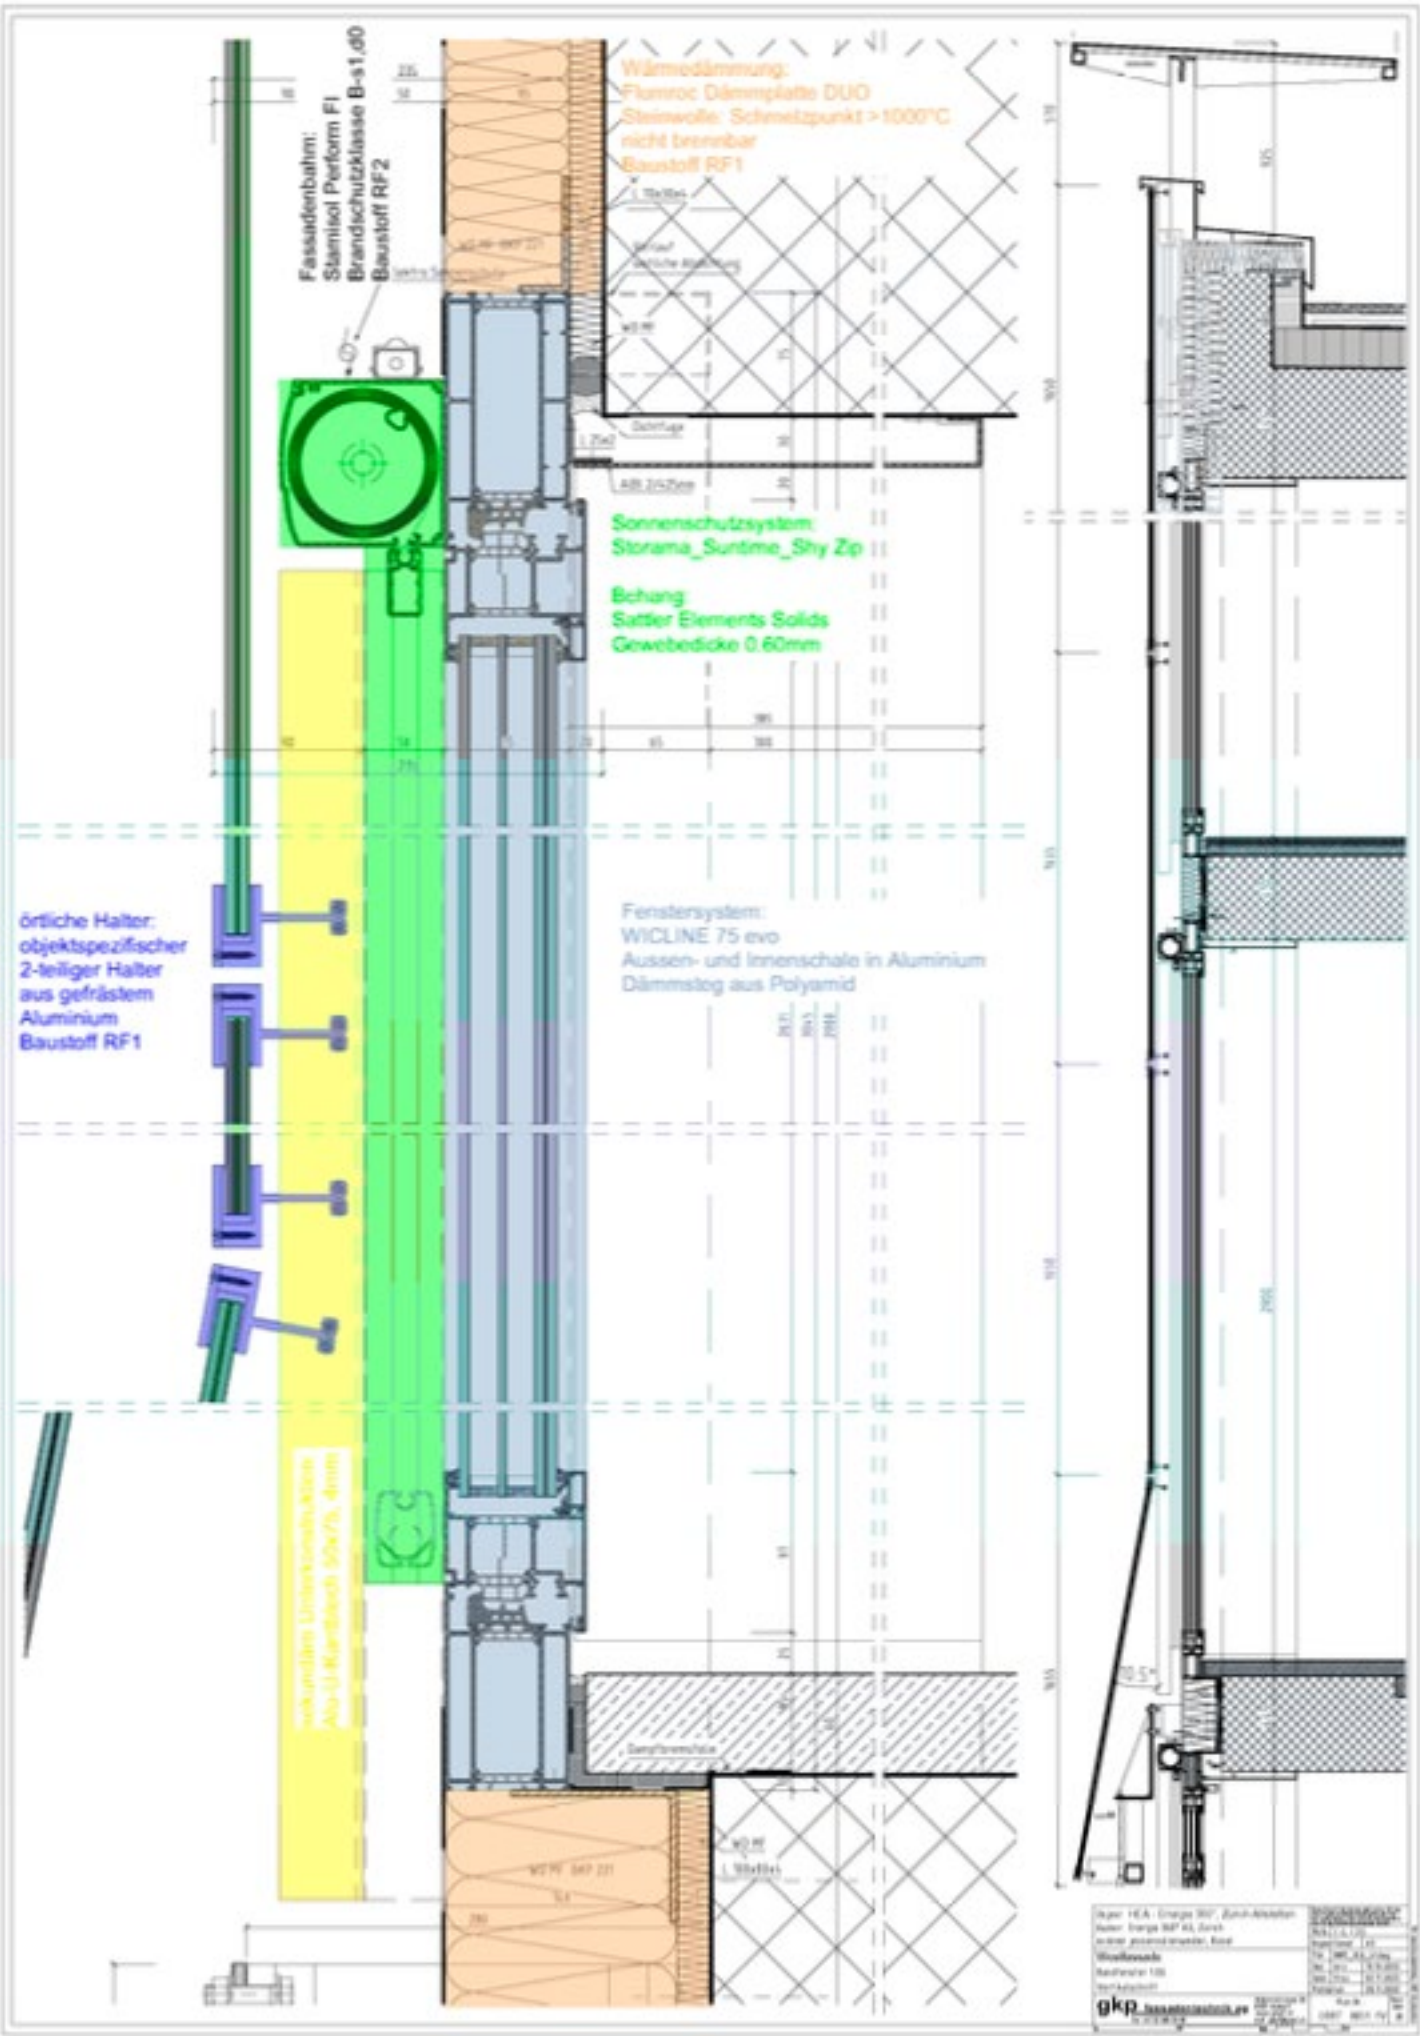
Detailansicht der Konstruktion Westseite des Bauvorhabens: PV-Modul vor Fenster, Bildquelle:[3]
